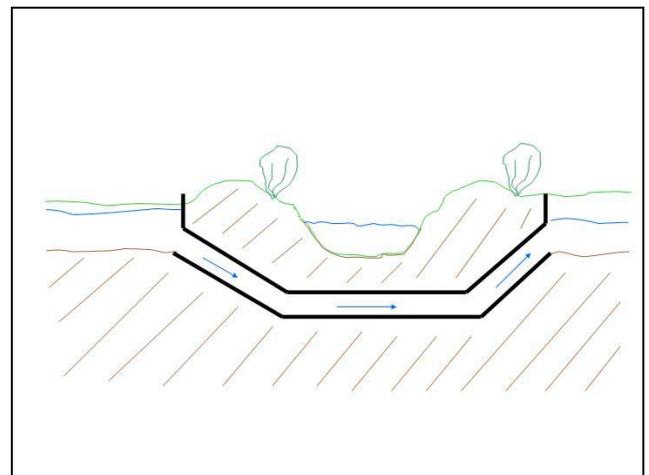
Zwei Gewässer kreuzen sich (Gewässerdüker Schemaskizze).
